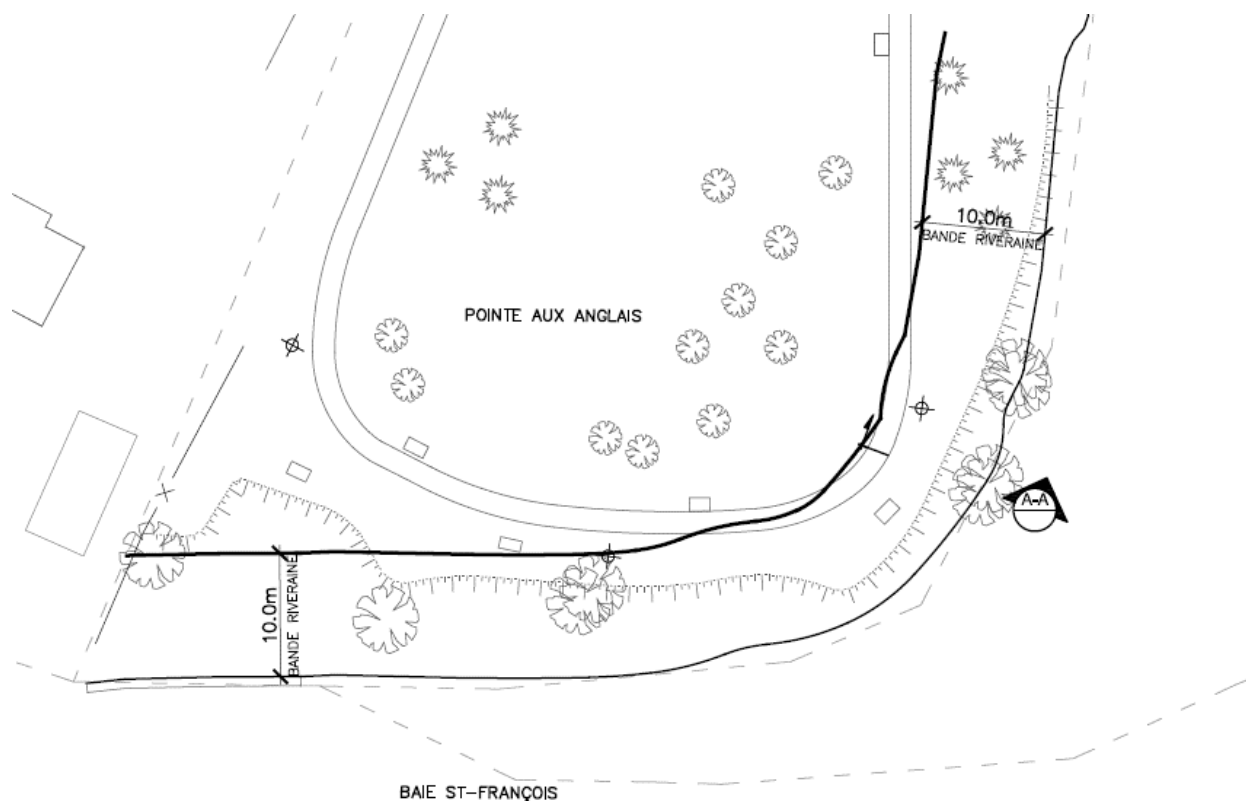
Vue en plan de la bande riveraine de 10 mètres (alternative Pointe-aux-Anglais)
